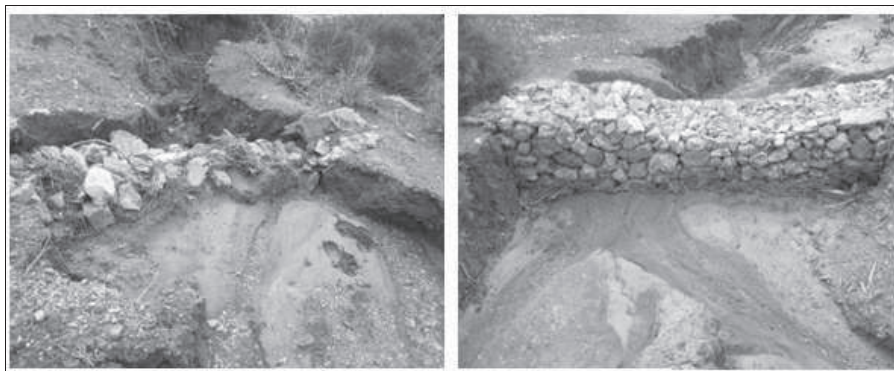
blocage des sédiments au niveau des seuils en pierres sèches au niveau du ravin sur le site de Sidi Sbea année 2014
